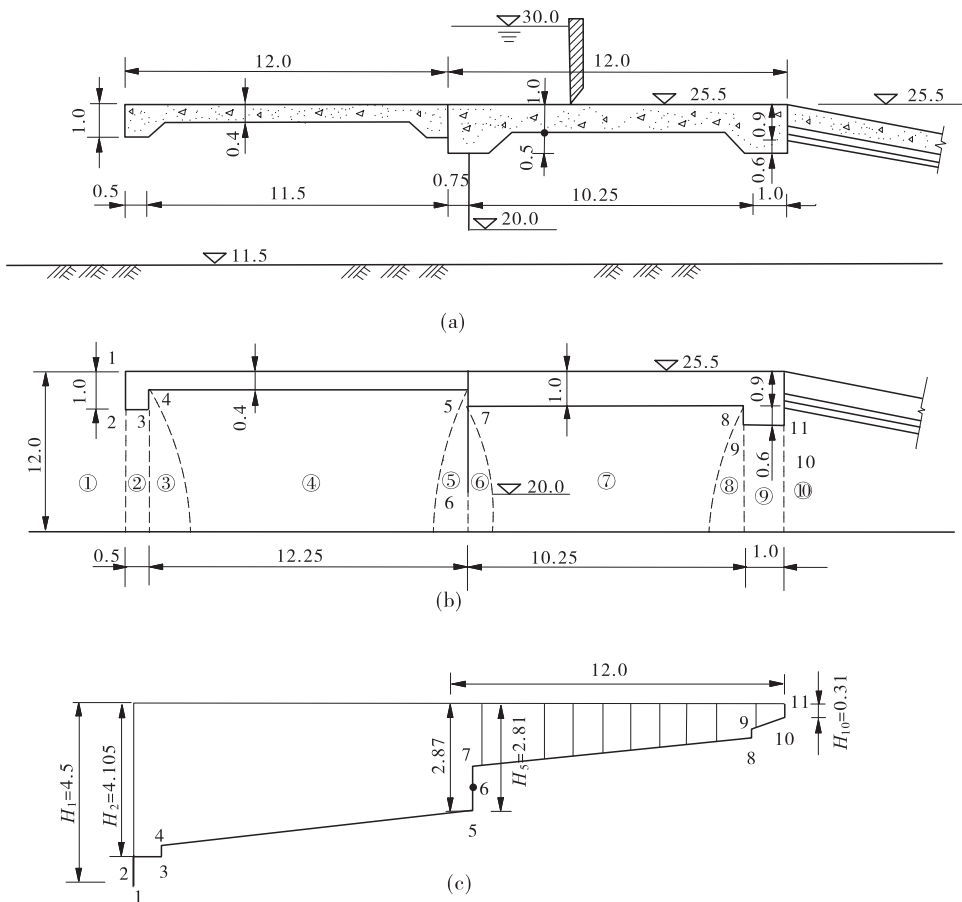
某水闸地下轮廓线布置及渗流计算图 (单位:m)
